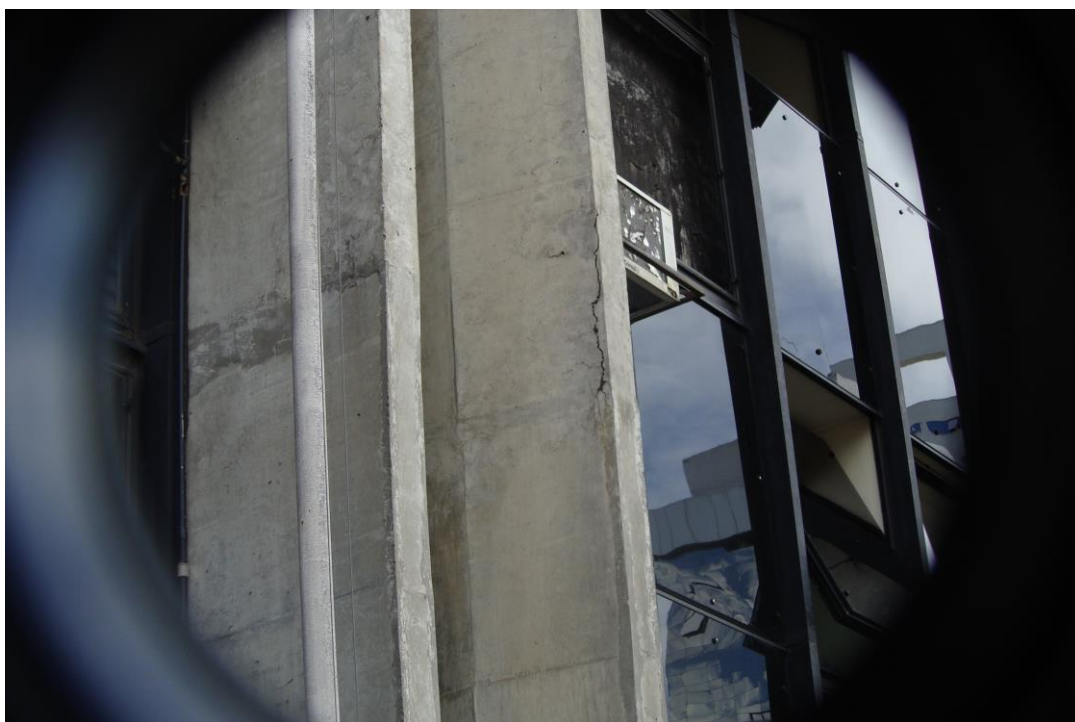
Armadura exposta pilar P12 (1º pavimento) (19/11/2013)
